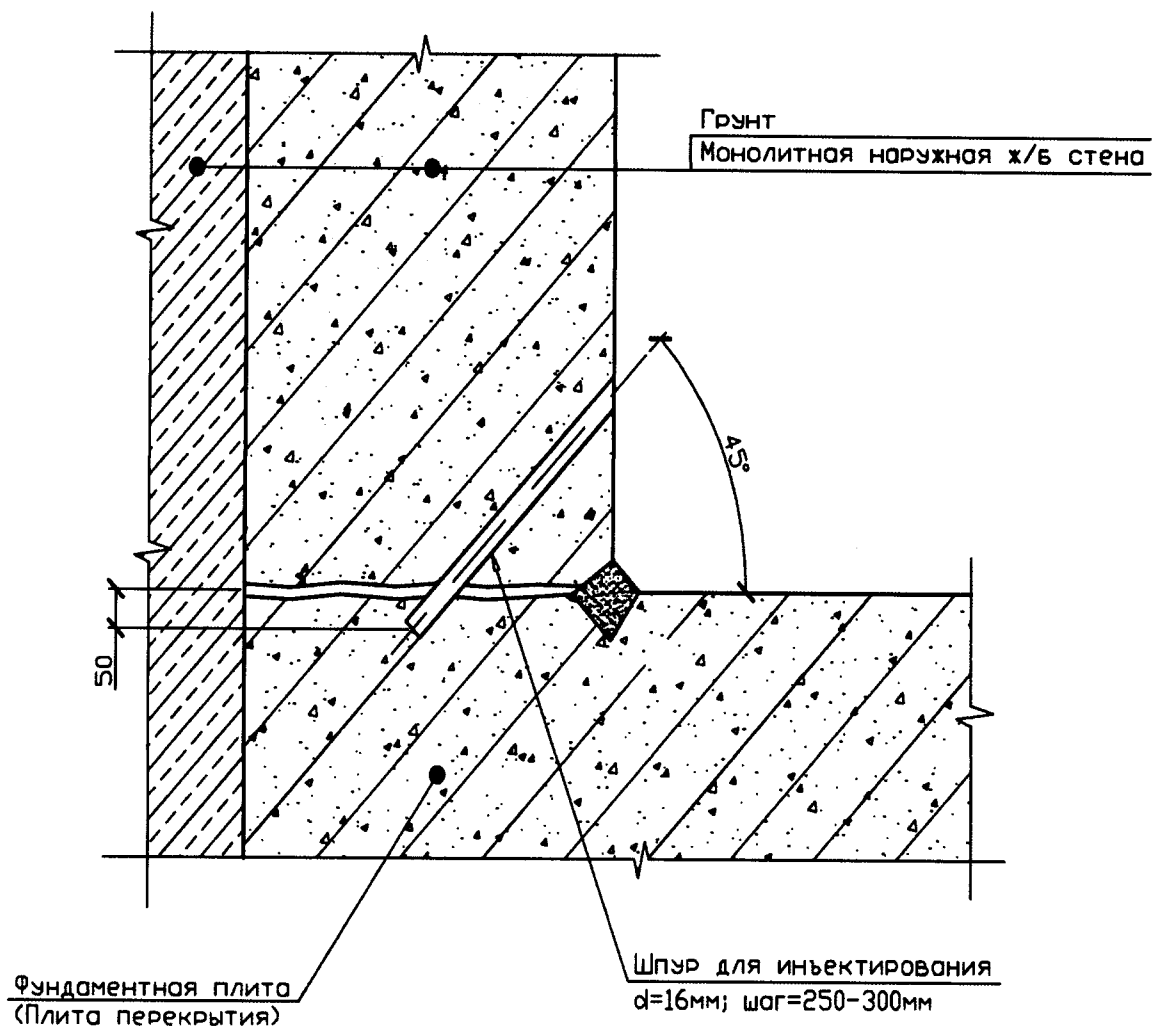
Герметизация конструктивных швов примыкания: «фундаментная плита-наружная стена», «плита перекрытия-наружная стена». Сверление шпуров
